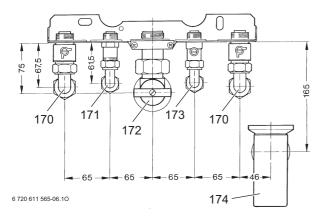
Piastra di allacciamento e montaggio con installazione sotto intonaco (installata)
